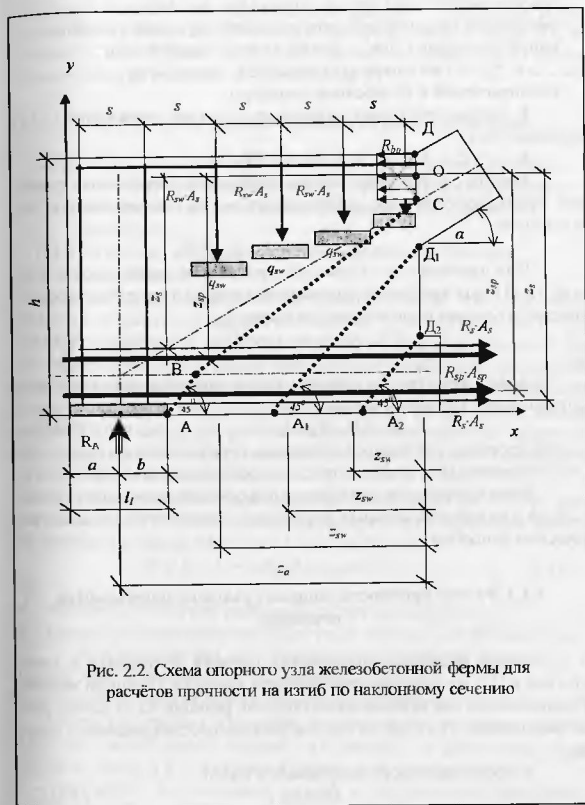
Схема опорного узла железобетонной фермы для расчетов прочности на изгиб по наклонному сечению
